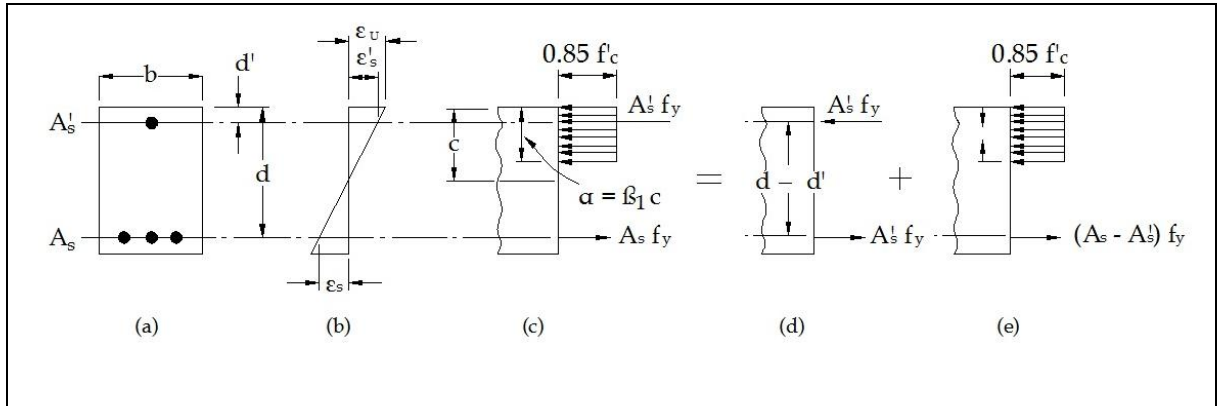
Sección de viga doblemente reforzada.
